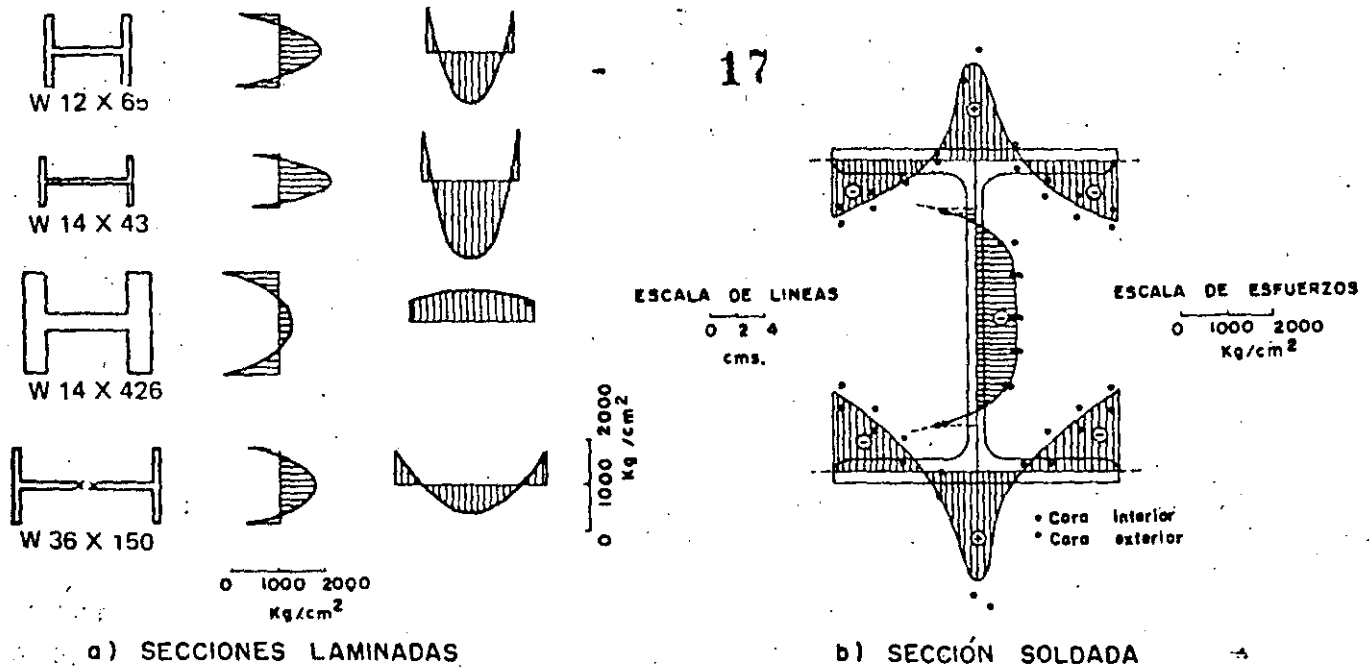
Esfuerzos residuales en sección I laminadas y soldadas
